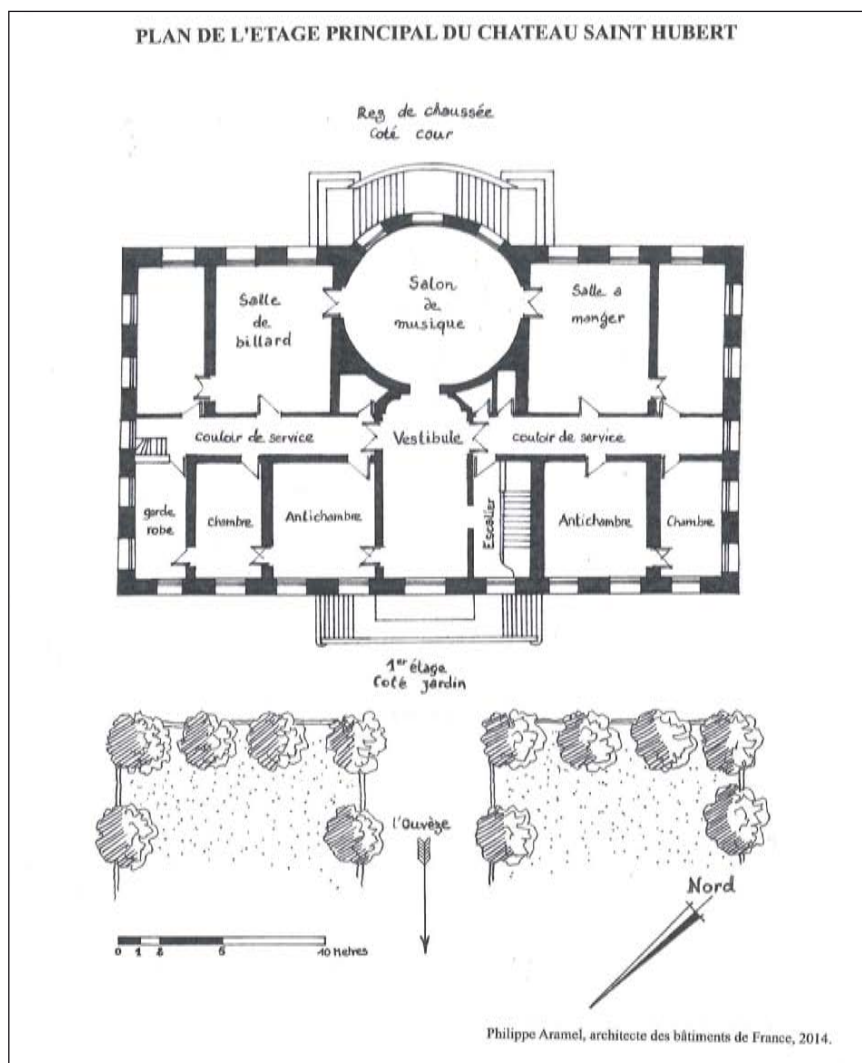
Saint-Hubert. Plan dressé par l'auteur.
